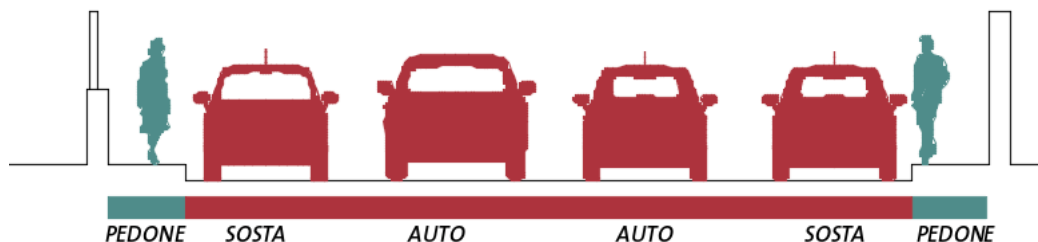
Sezione stradale di via Alessandro Lopiccoli, stato attuale
